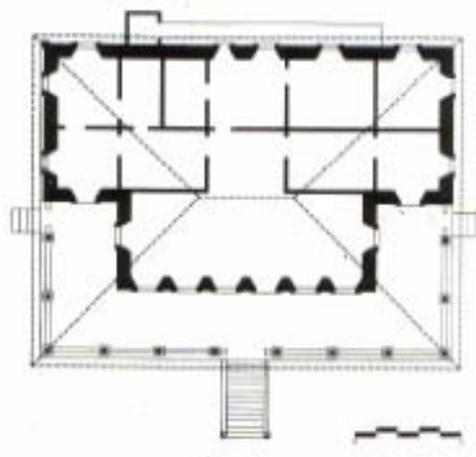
Planta Baixa da Casa Grande do Engenho Santa Helena, em Água Preta –PE.
